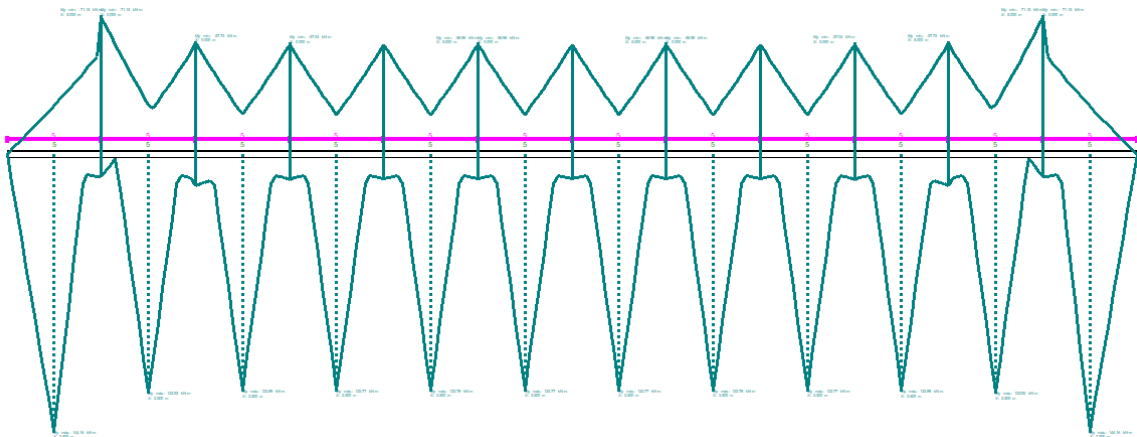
Esfuerzos sobre la viga carril. Fuente: CYPE 3D.
